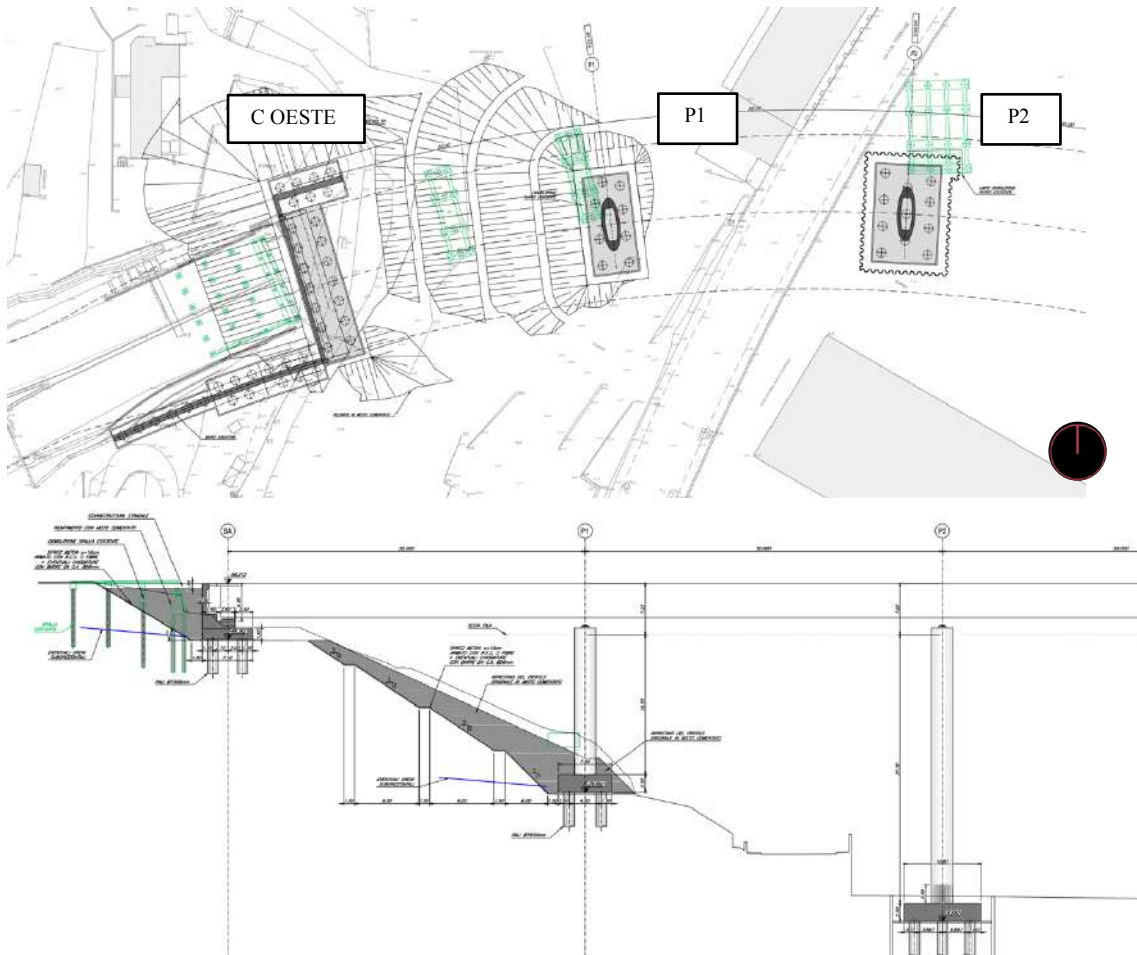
Planta e elevação da cortina de contenção oeste, dos pilares elípticos P1, P2 e respectivas fundações. Fonte: Adaptada de ITALFERR
